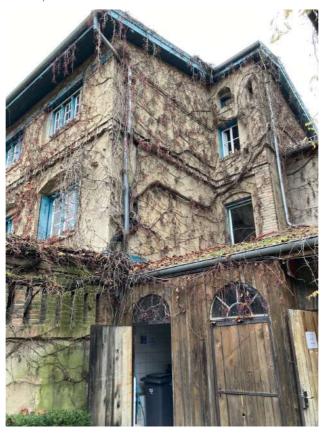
Vue de la façade Sud du château avant travaux – Source ARCHIMED Environnement
